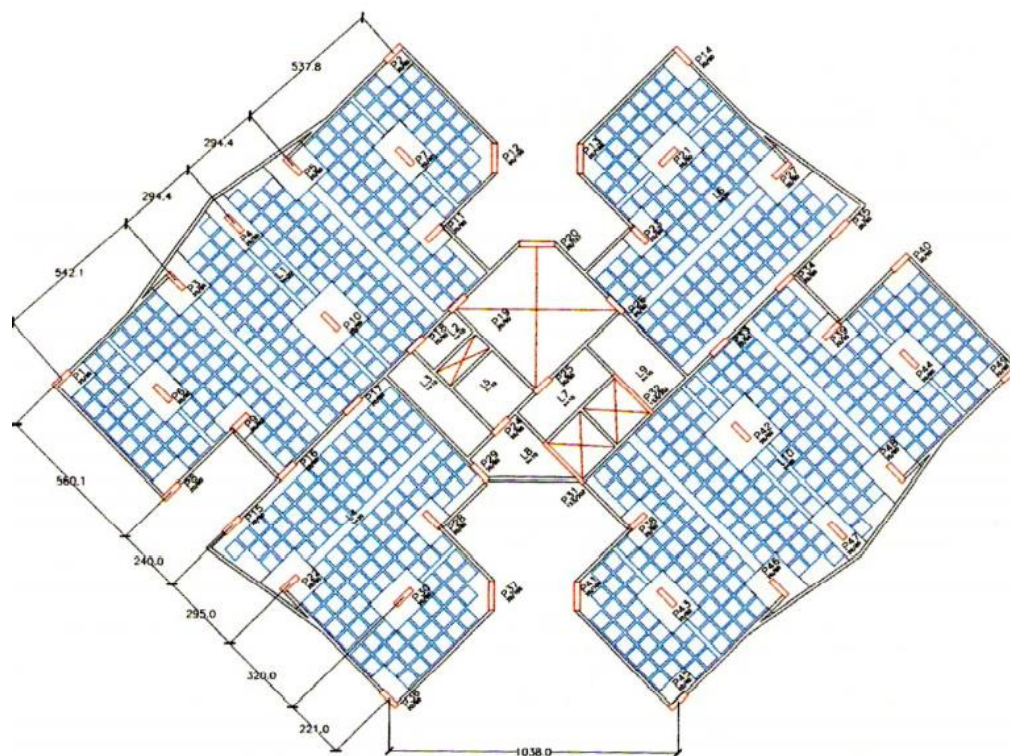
Planta baixa do terceiro exemplo (MARTINS, 2003) – cotas em cm
